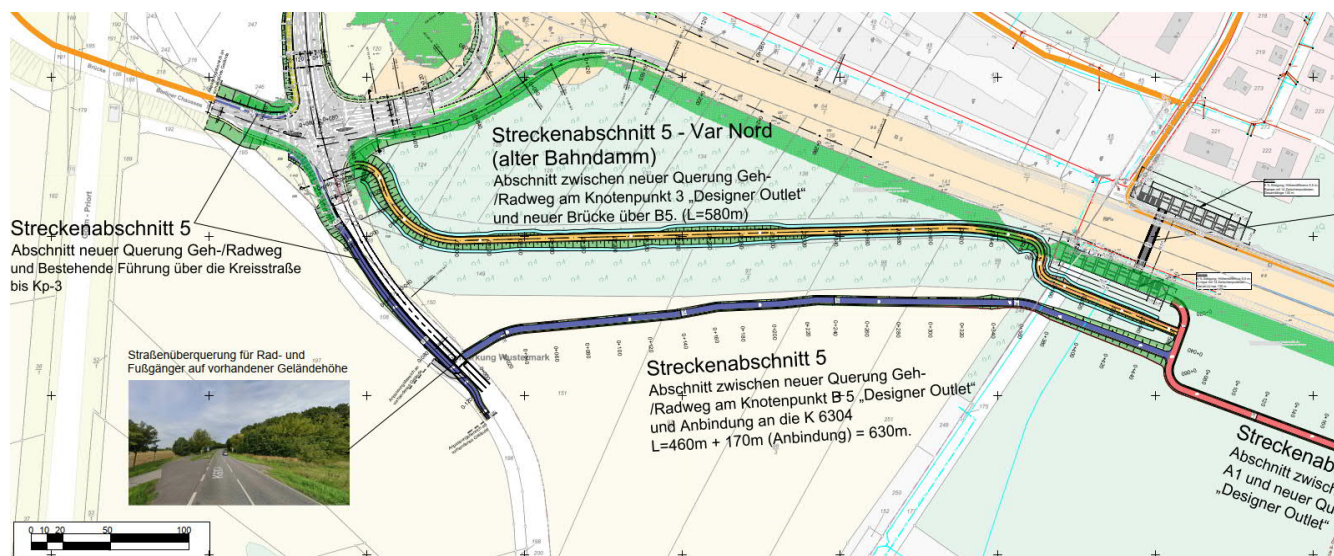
Ausschnitt Übersichtsplan Radverkehrsführungen Variante Nord, Variante Süd 1 und Variante 2
